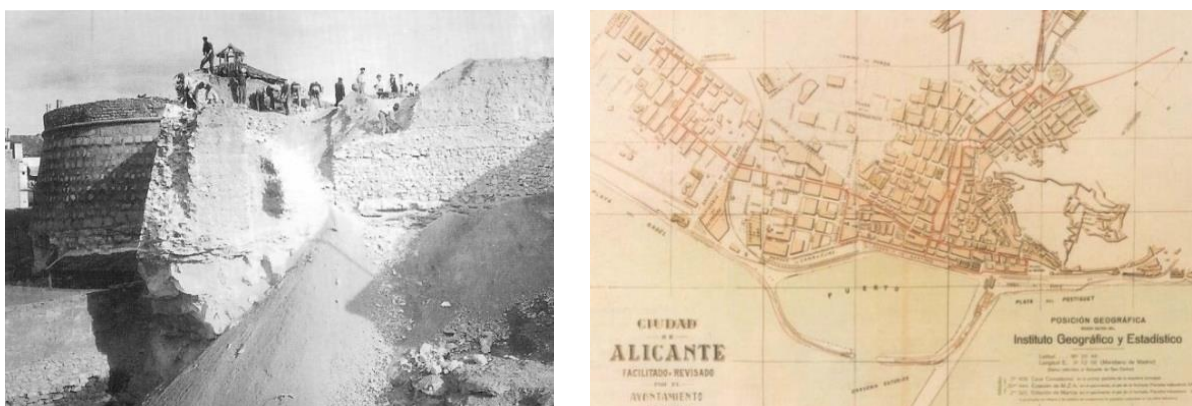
Derribo de la muralla de Alicante y proyecto de Ensanche
